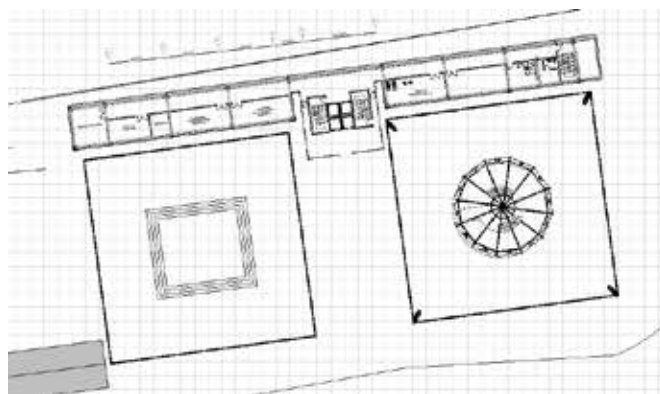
Planta Baja - Nivel +- 0.00. (2016)
